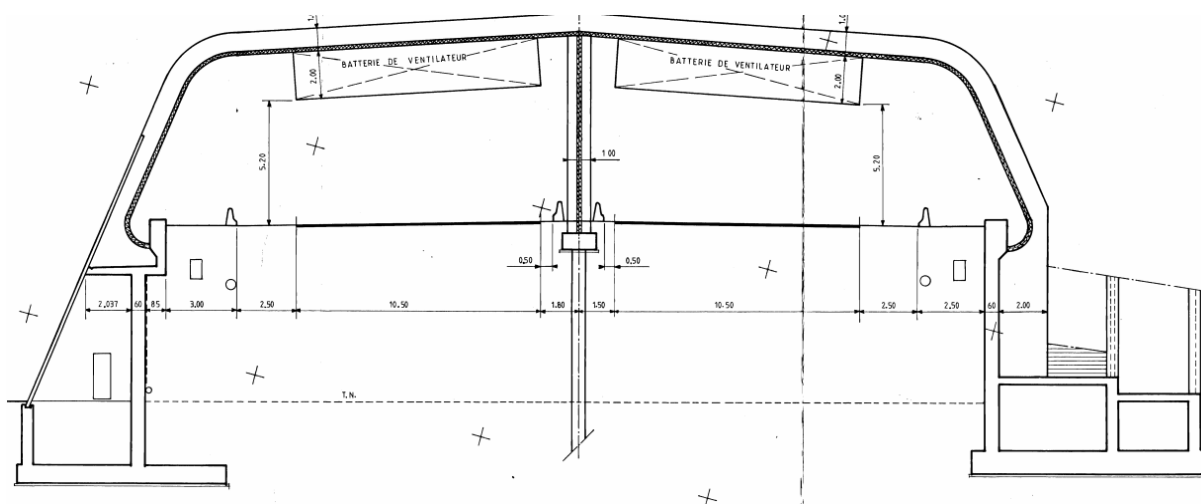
Coupe de la structure porteuse de la plateforme autoroutière
